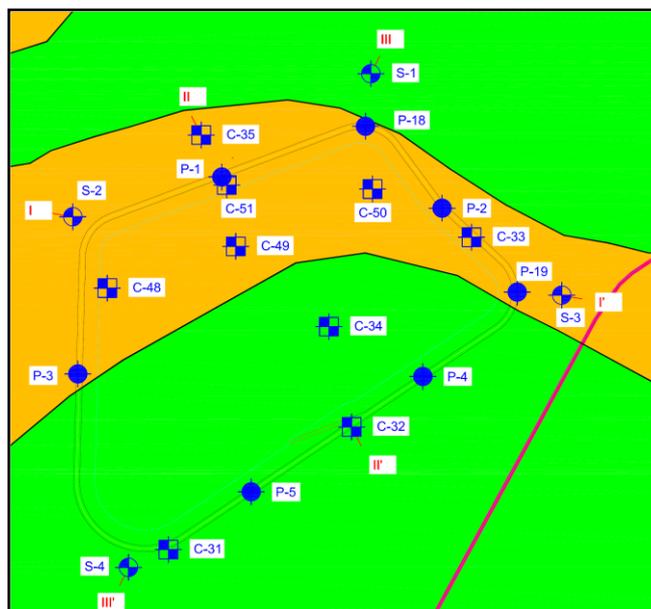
Localización de los trabajos de campo. Planta balsa Sector II.
